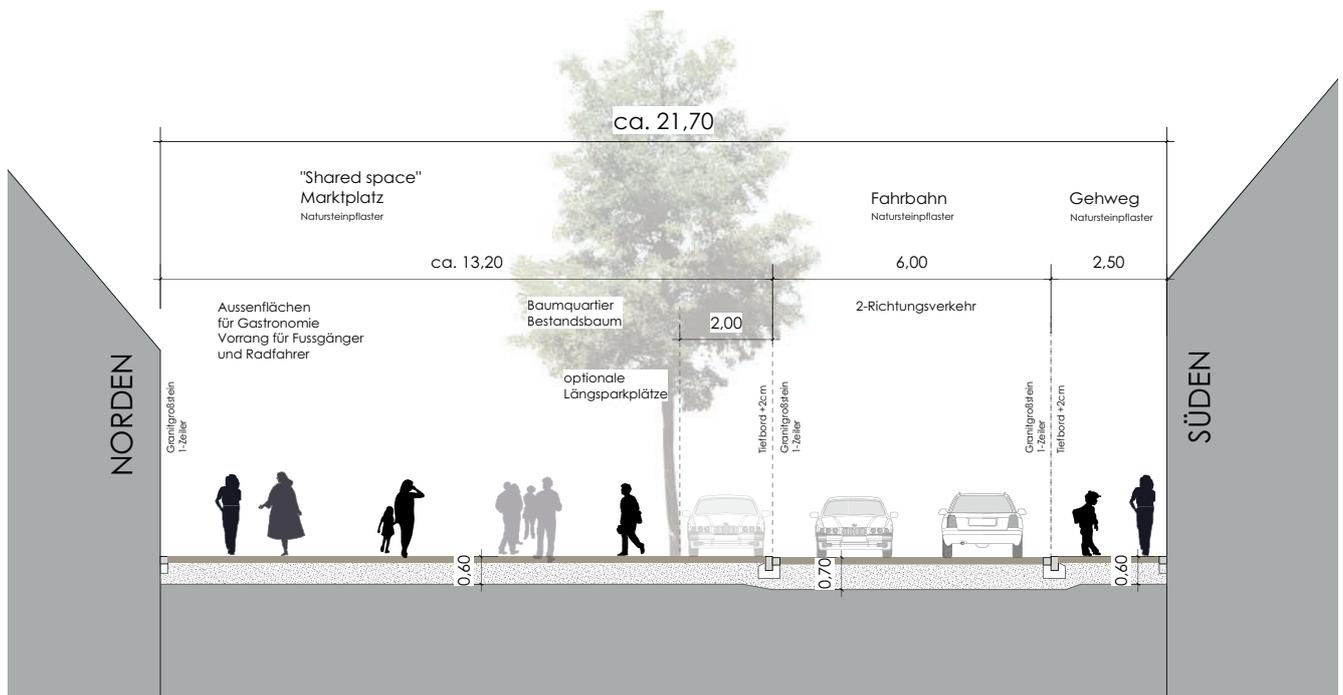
Gestaltungsschnitt Marktplatz (o.M., Entwurf und Zeichnung LAB RÖTH)
